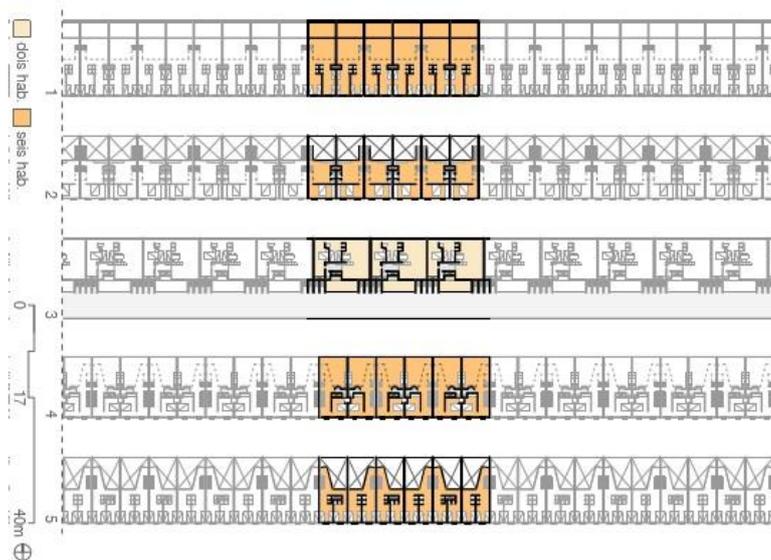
Hipótese para a organização da planta baixa da barra⁴⁴.
